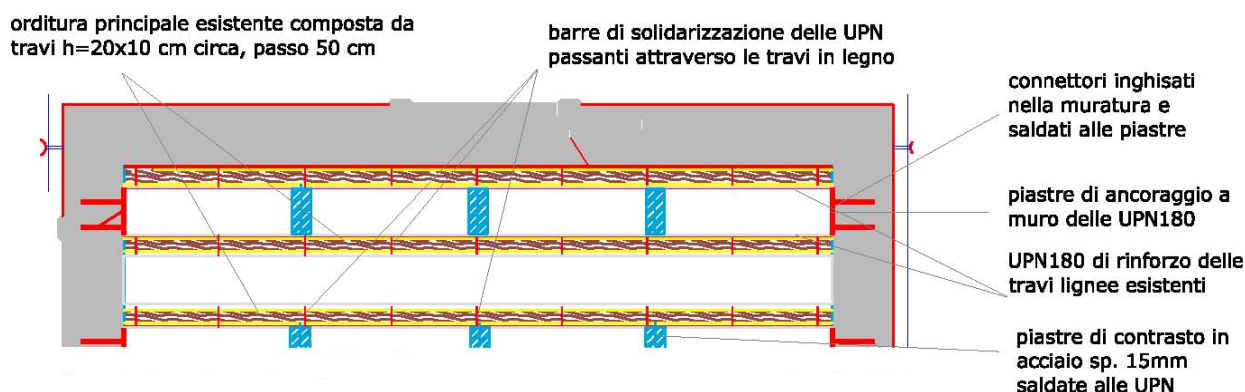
Stralcio di pianta del solaio di piano primo con il consolidamento intradossale.
